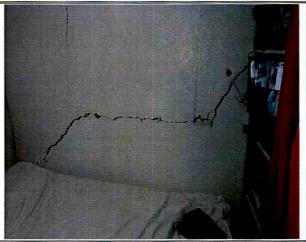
Condiciones muro divisorio Predio 2. Fotografía tomada el 17/04/2018
